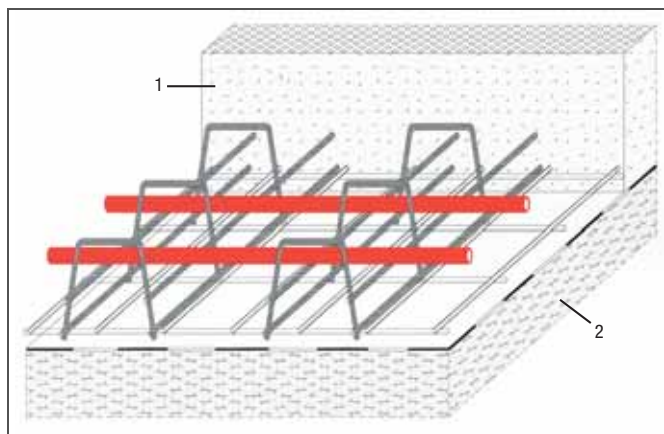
Бетонная плита, армированная стальной арматурой; специальная конструкция смонтированных отопительных плит по центру плиты
